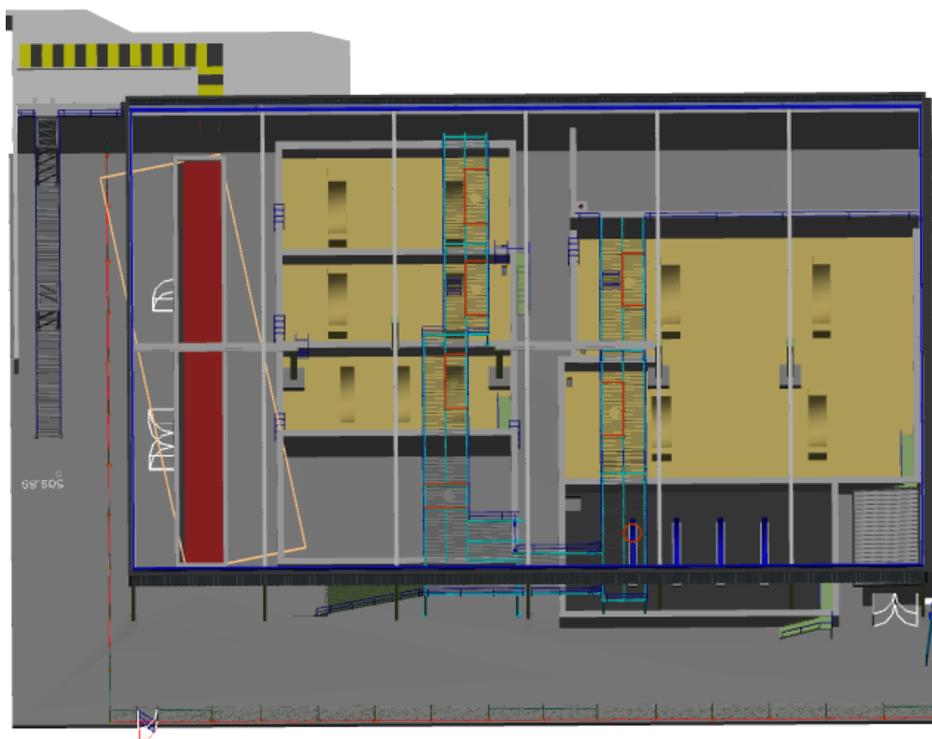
Planta de la nave y exteriores de la zona de almacenamiento de fluidos.
